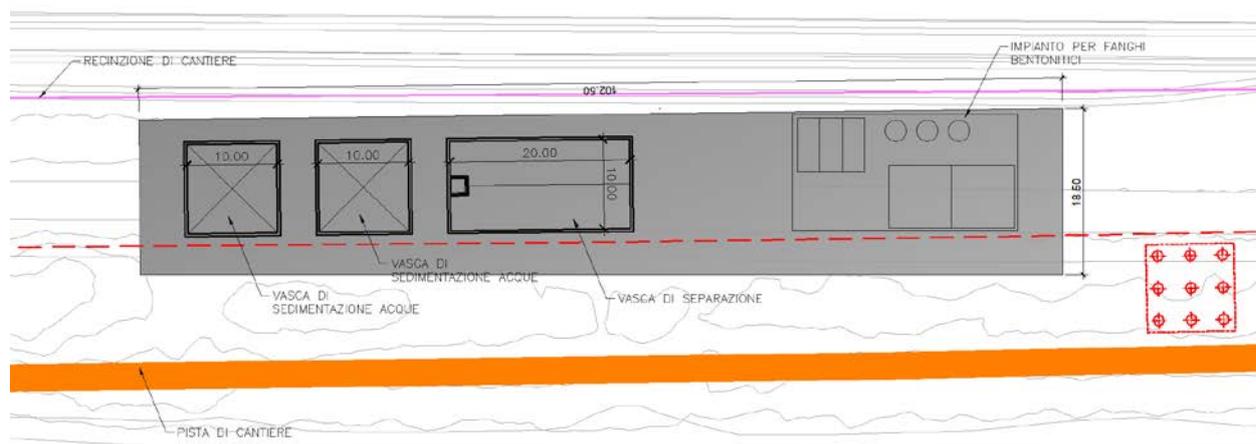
Layout progetto Cantiere Operativo Temporaneo COO2
